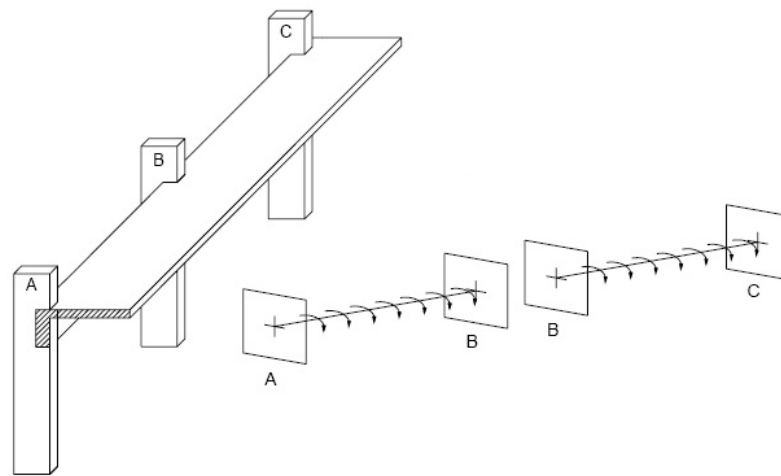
Viga contínua sob torção por efeito de laje em balanço.
